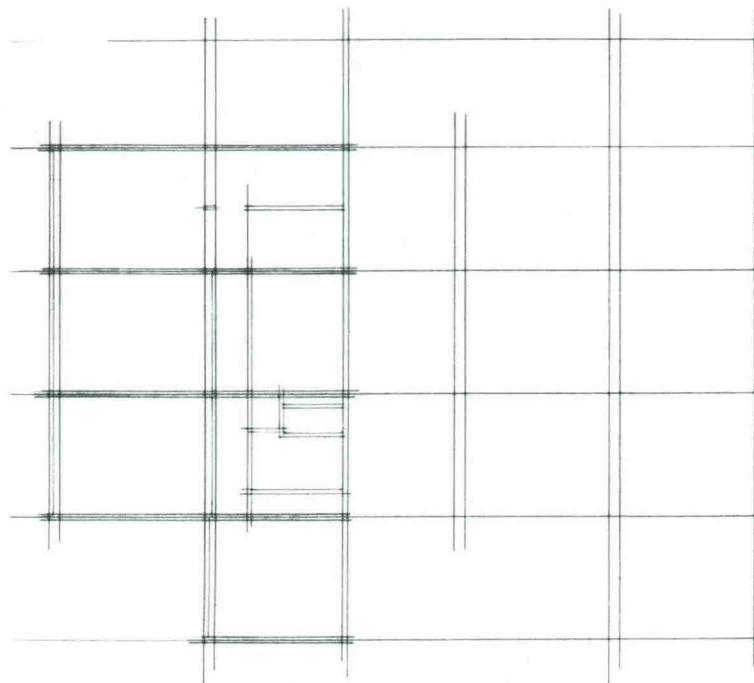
平面图的初步确定 引自《ARCHITECTURAL GRAPHICS, Fourth Edition》
